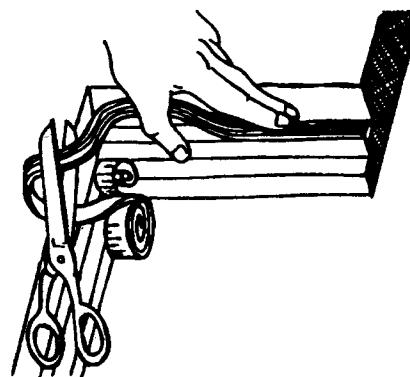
Установка самоклеющейся уплотняющей прокладки с защитной пленкой
